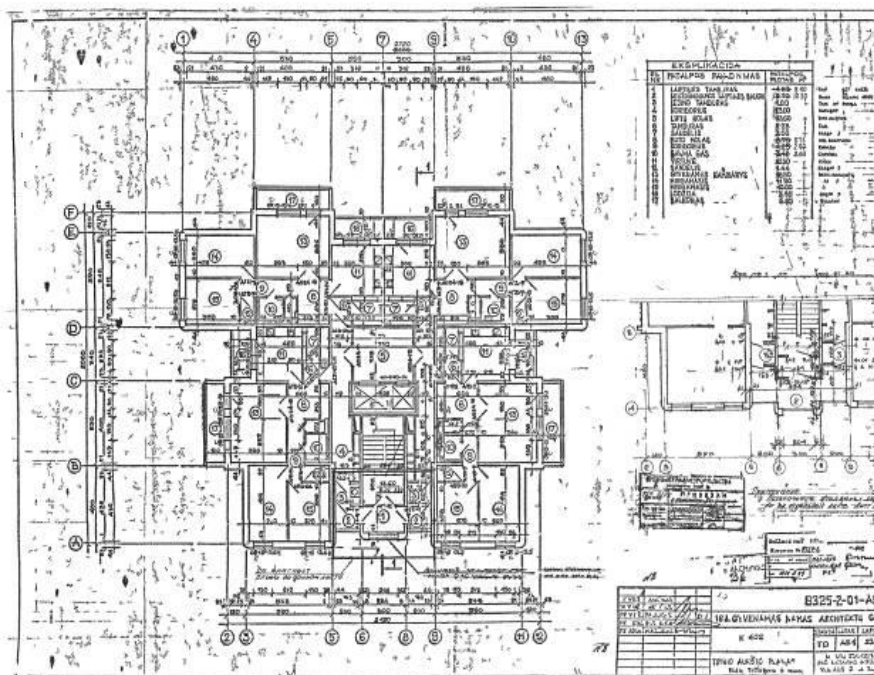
Схема розташування приміщень типового поверху (за даними проекту) дослідженої будівлі
